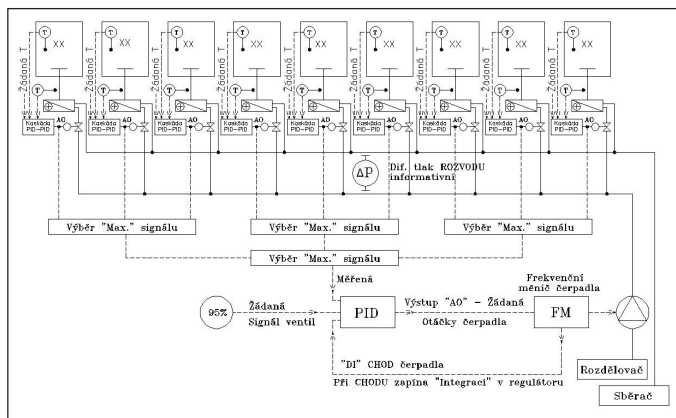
Řízení otáček čerpadel pro běžné soustavy
